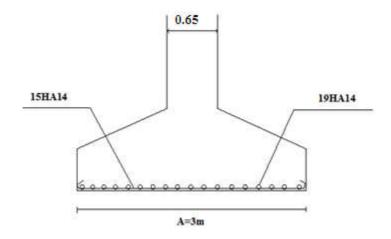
Schéma du ferraillage de la semelle (65*40).
